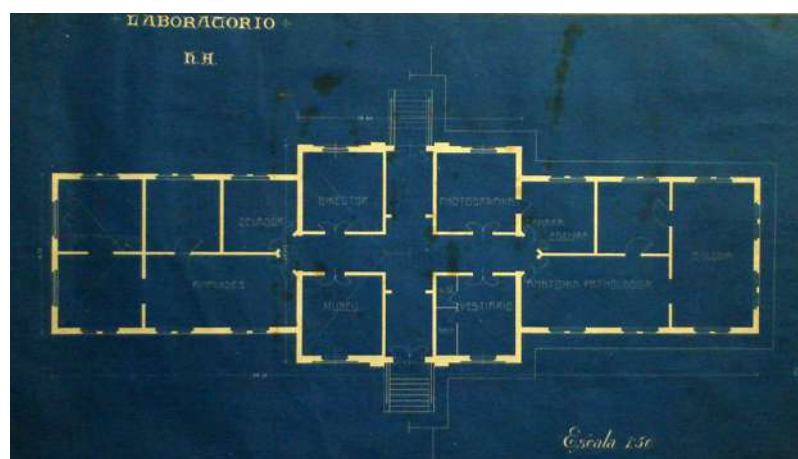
e 161 – Reprografia da Fachada e planta baixa, assinado pelo Eng. Prestes Maia (acervo do museu Osório César).
